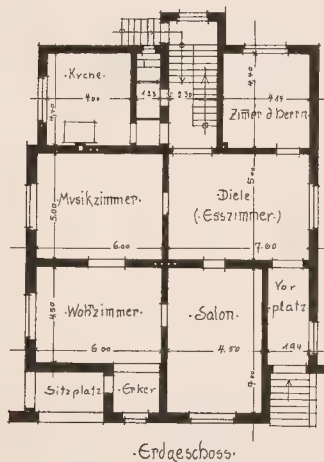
Landhaus Meyn; Grundriss.
